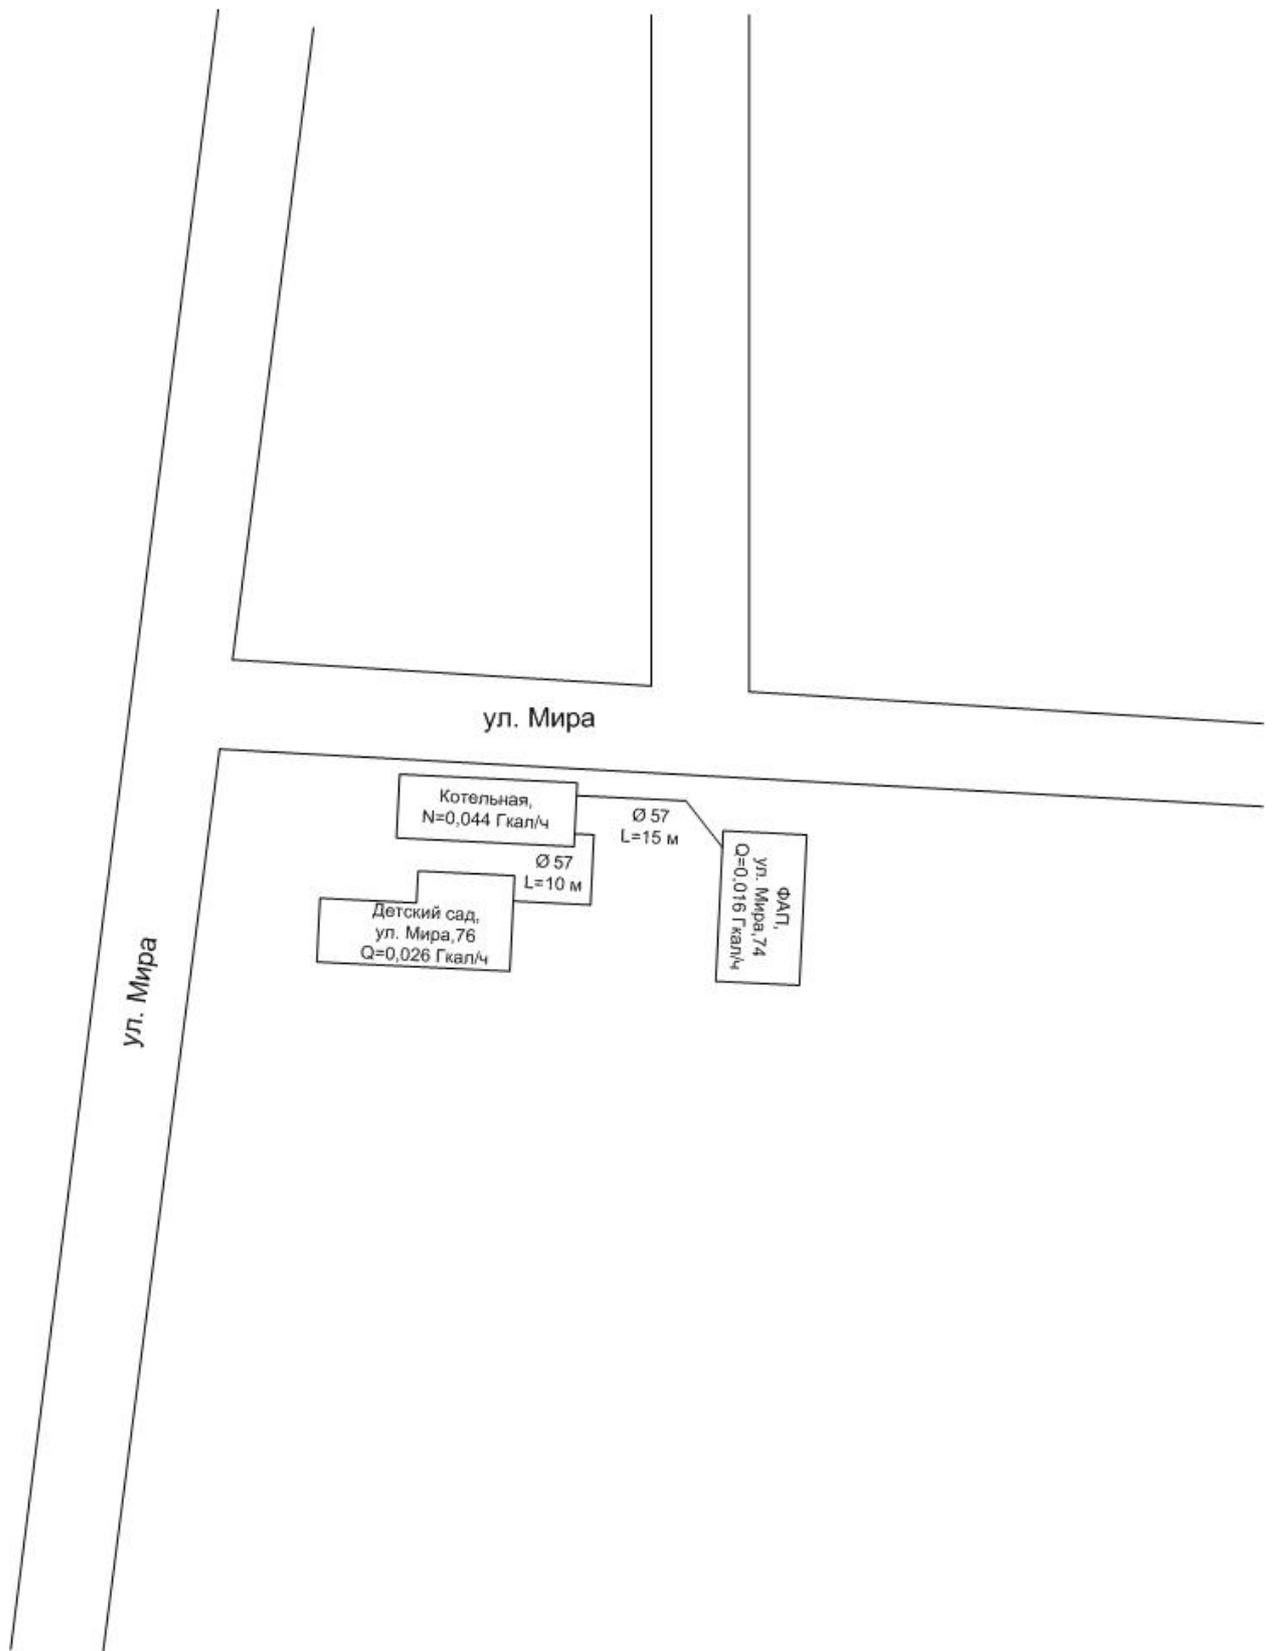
Схема тепловых сетей котельной детского сада с. Шилан
